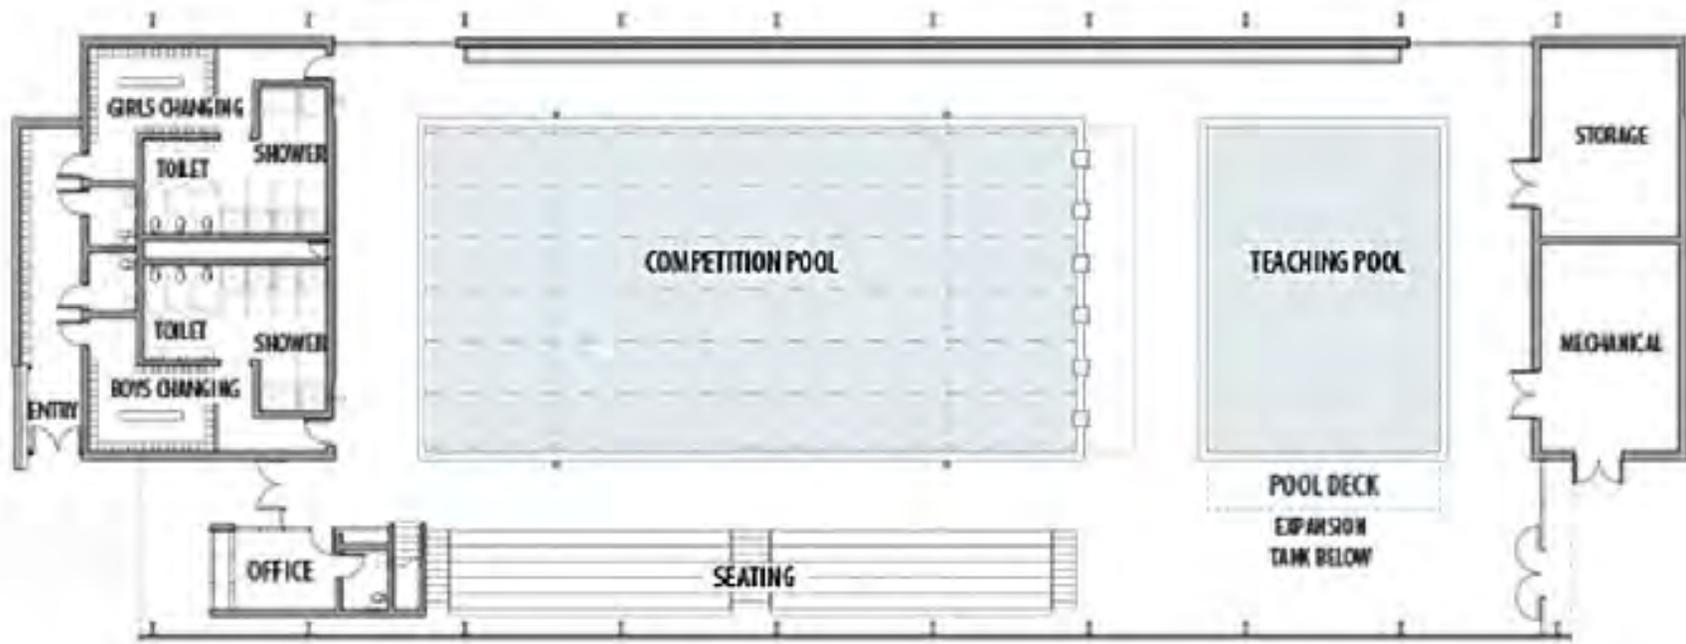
Planta Arquitectónica del centro acuático AIS7.
